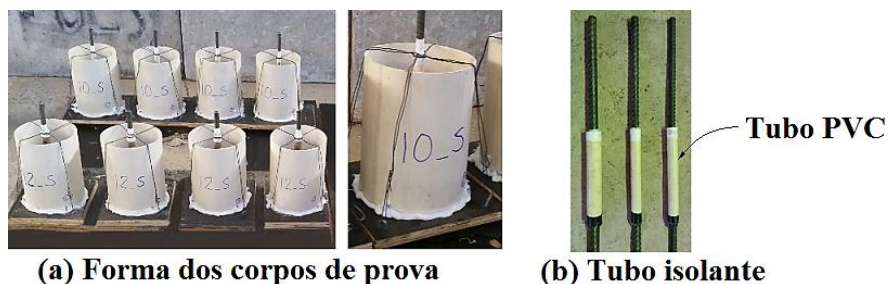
Formas construídas e tubo isolante dos corpos de prova para da Etapa I.
